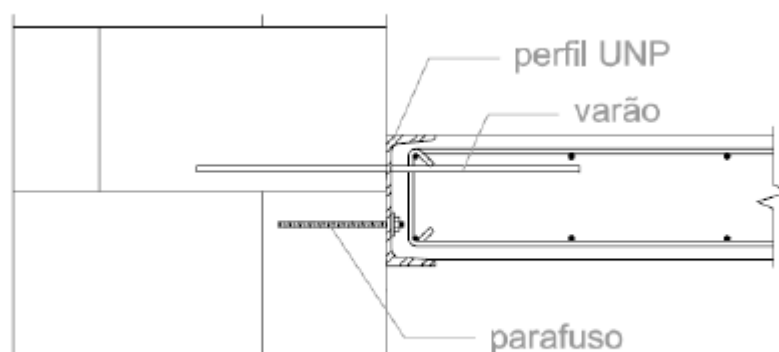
Ligação da laje de betão através do perfil UNP
